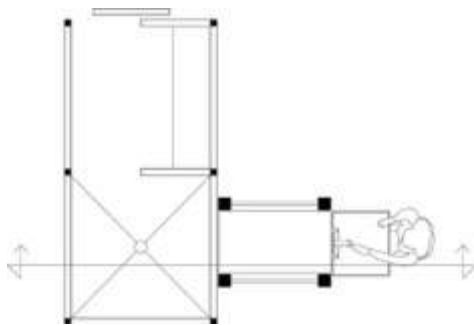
Planta esquemática de baños regadera. Fuente: Elaboración en equipo.
